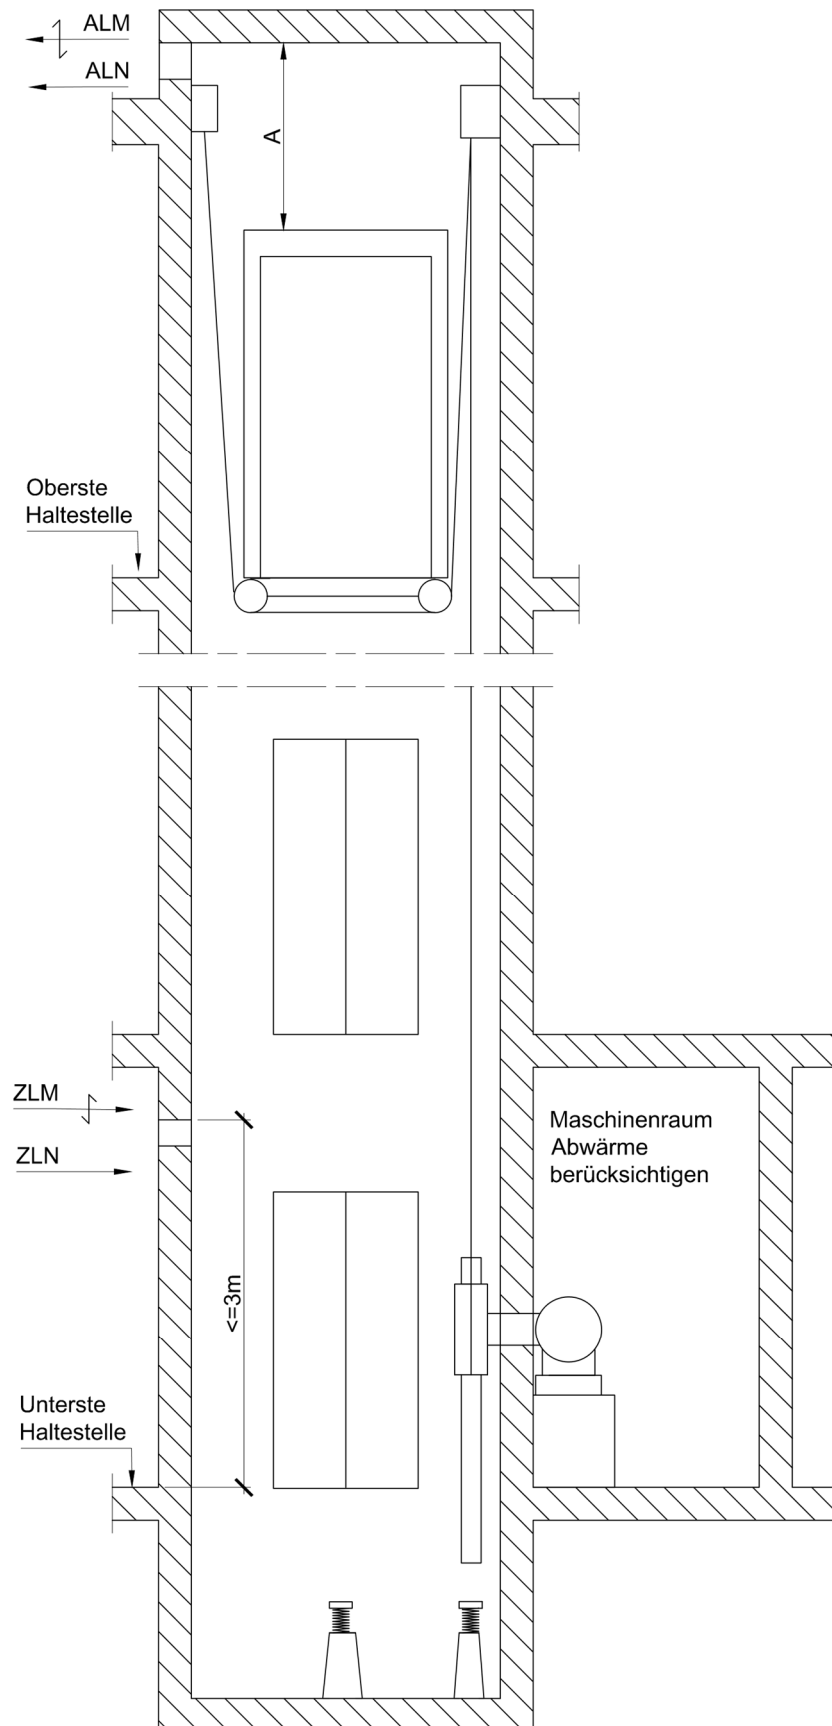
Aufzug mit Maschinenraum unten seitlich
